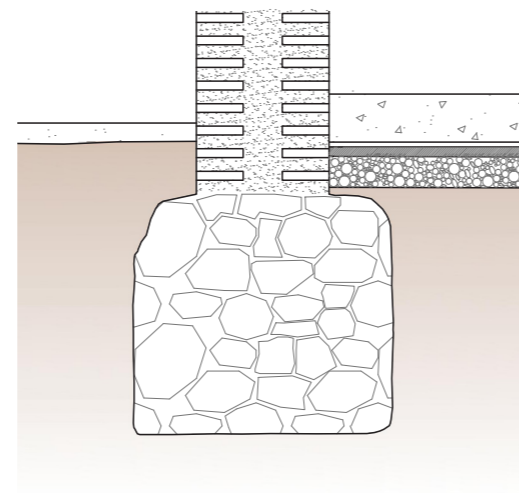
Detalle de la supuesta cimentación del edificio. Autor Propio 2015
